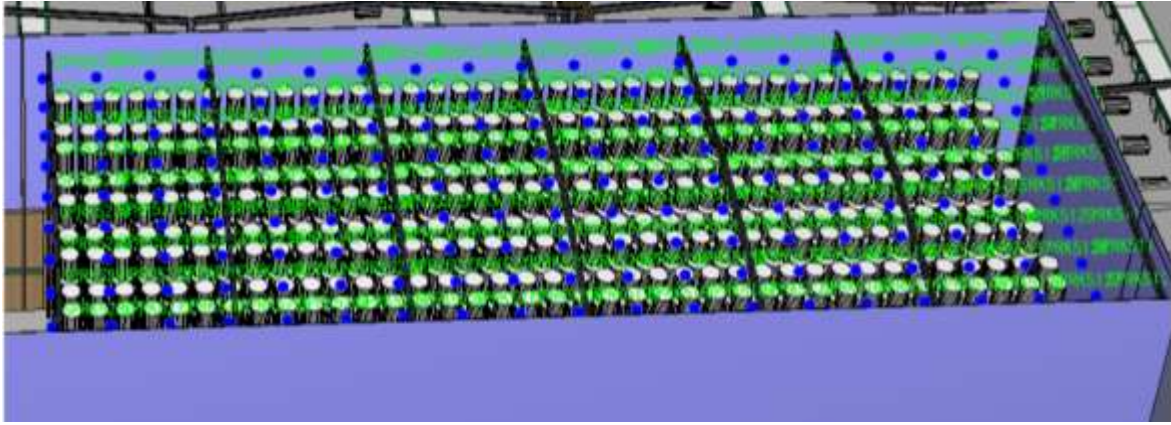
Pormenor dos sprinklers da cobertura do armazém PRS2
